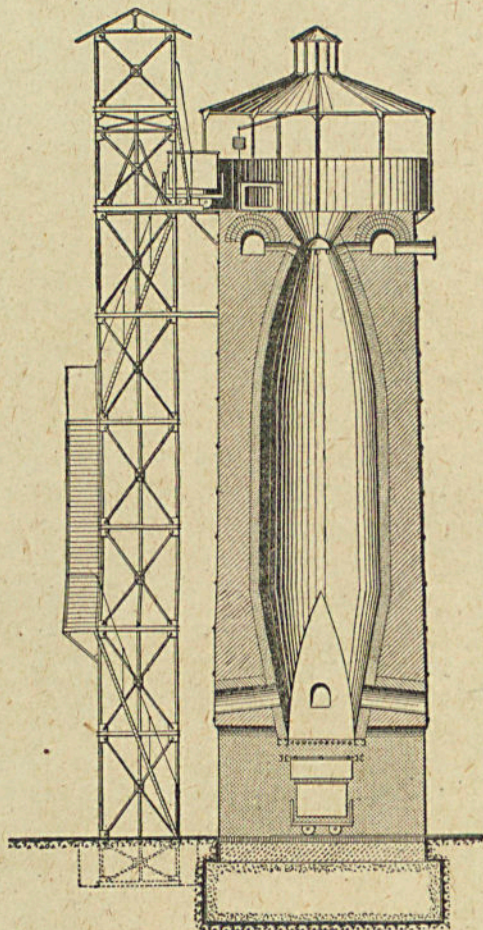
Four à Chaux type Khern (Etablissements Maguin. Coupe).
